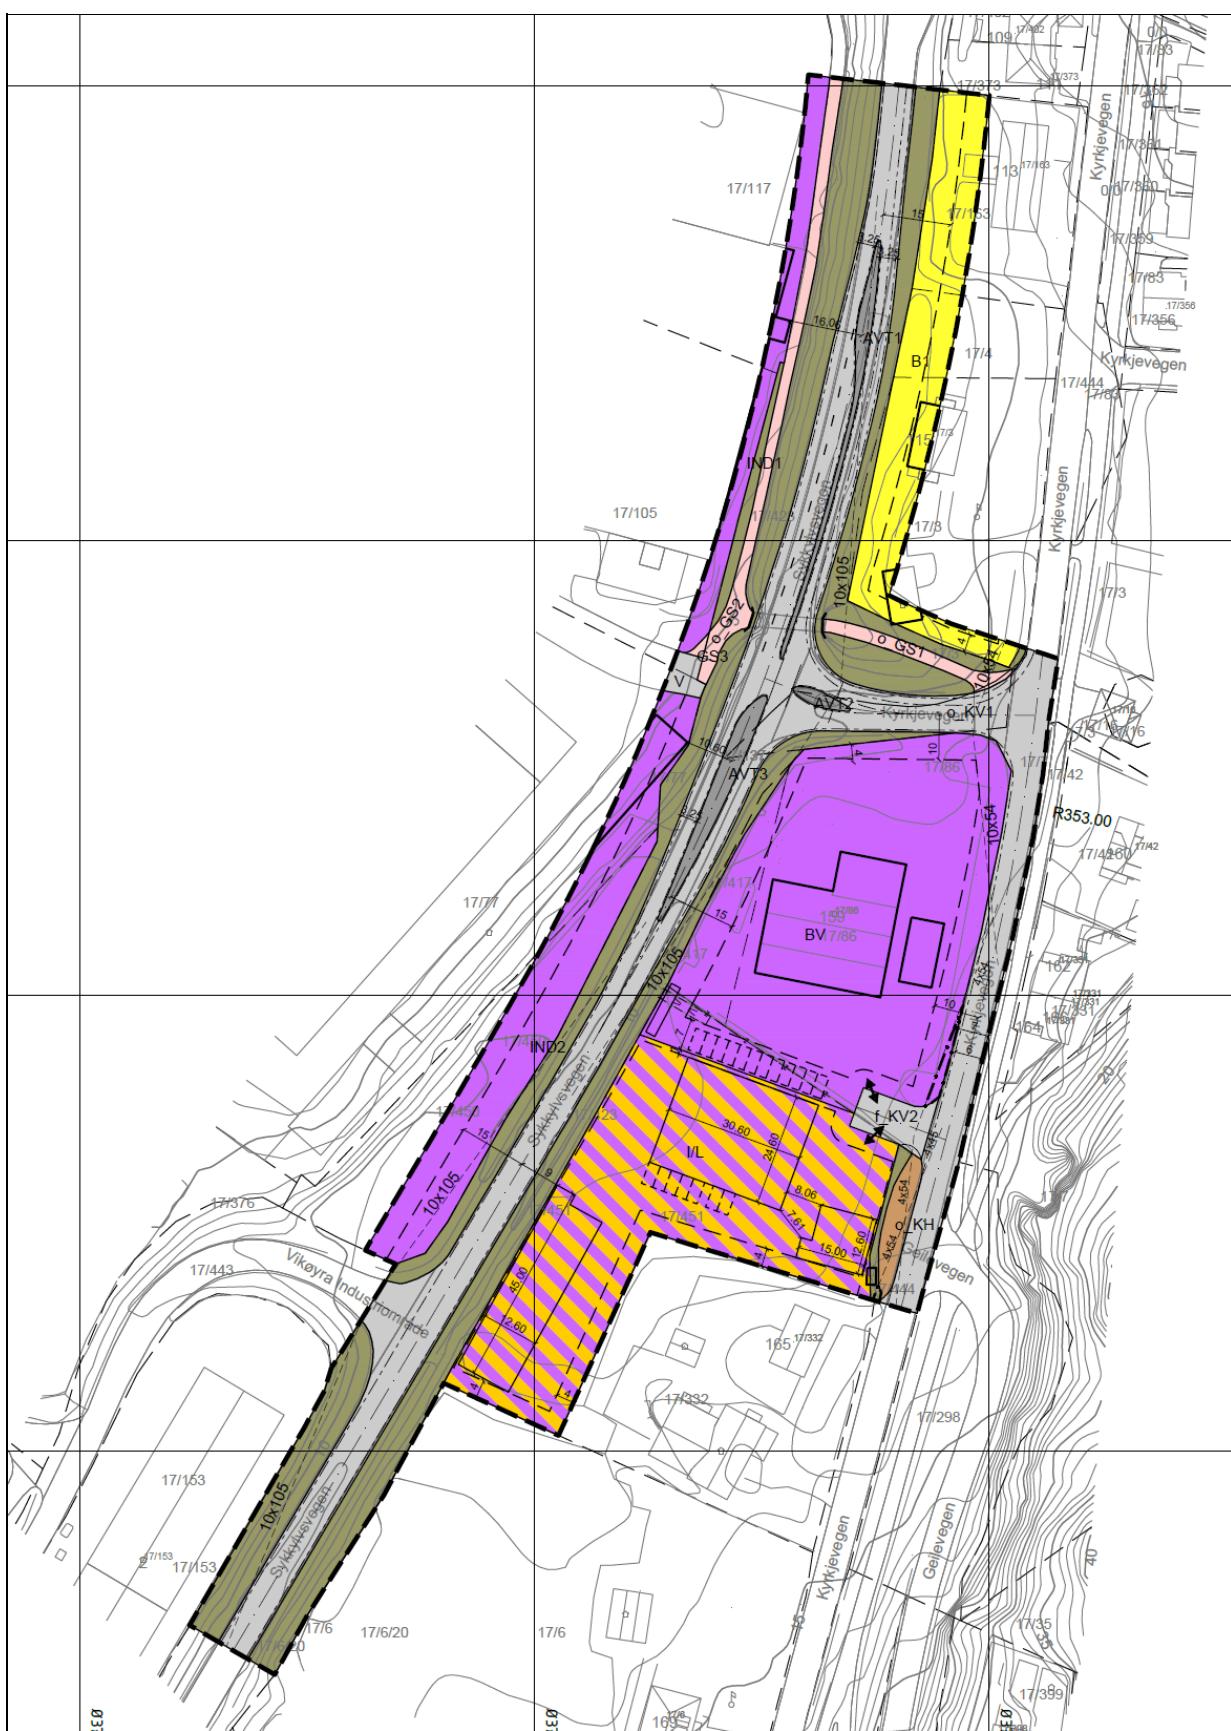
Forenkla planutkast RPO6 11.1.24 for vurdering av utstrekning planområde med kryss FV.60 Sykkylvsvegen x KV1046 Kyrkjevegen. For planområde tilsvarende dette, sjå fig.2.
